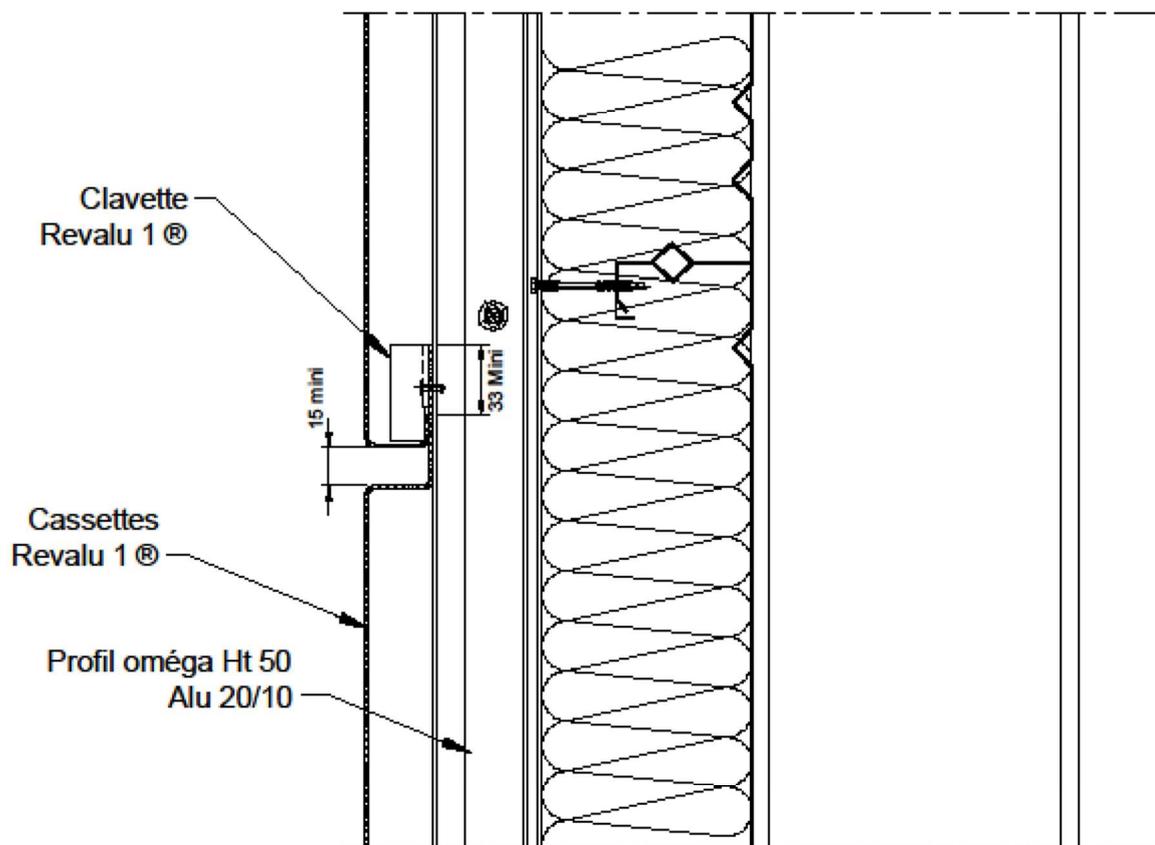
Coupe verticale sur joint horizontal (support bac plateau)
